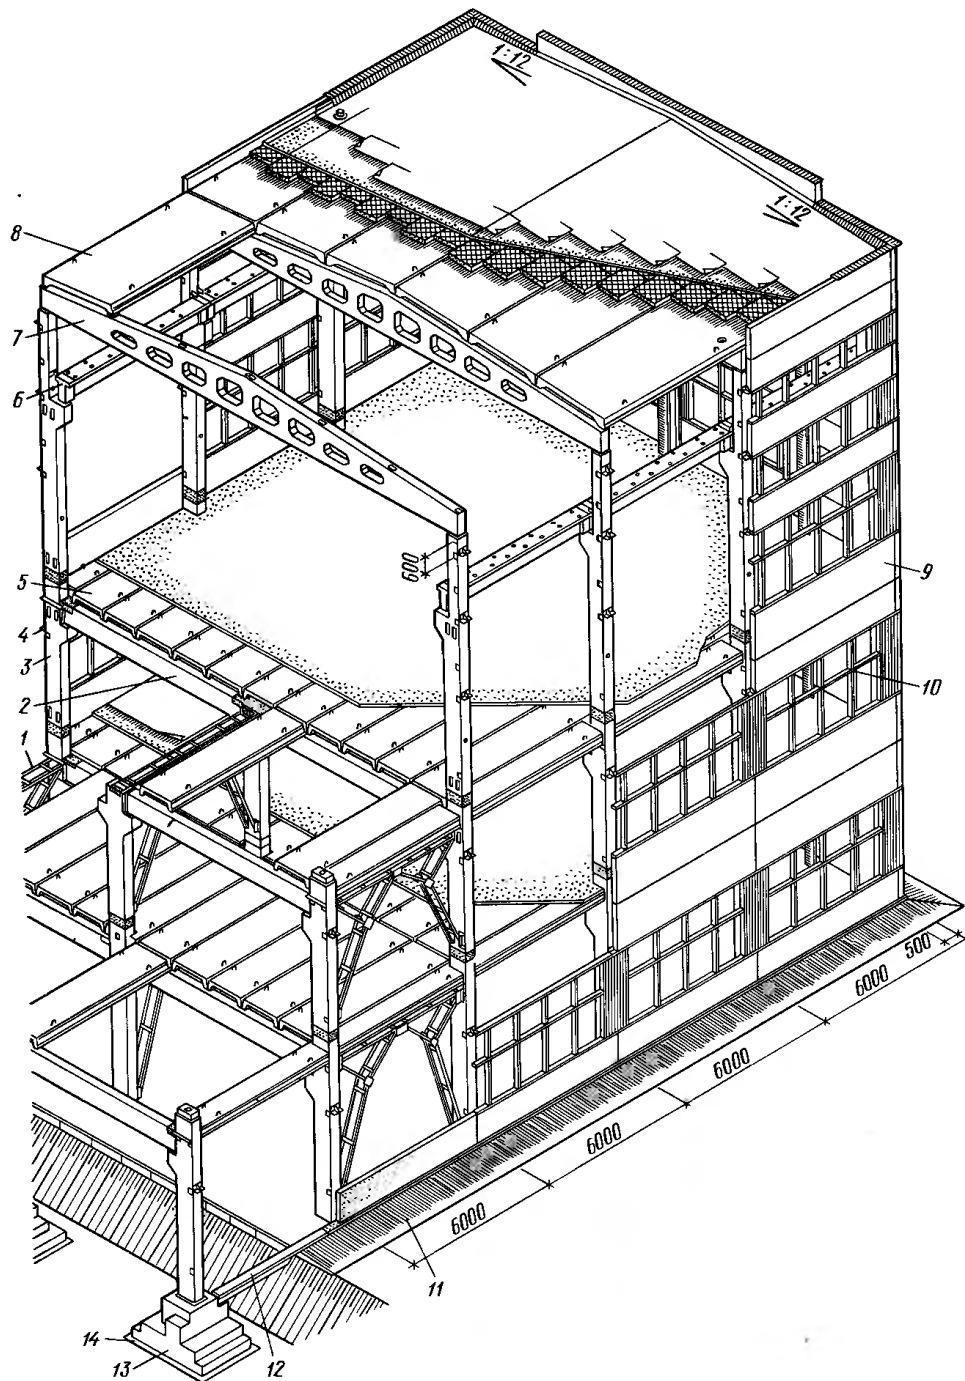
6. Конструктивне вирішення багатоповерхової будівлі: 1 – вертикальний зв'язок між колонами; 2 – ригель; 3 – колони; 4 – монтажний столик для оперття стінових панелей; 5 – плита перекриття залізобетонна, ребриста; 6 – залізобетонна підкранова балка; 7 – залізобетонна двосхила балка покриття; 8 – залізобетонна плита покриття; 9 – стінова панель; 10 – зашклення; 11 – вимощення; 12 – фундаментна балка; 13 – бетонний прилив для оперття фундаментних балок; 14 – піщана підготовка
